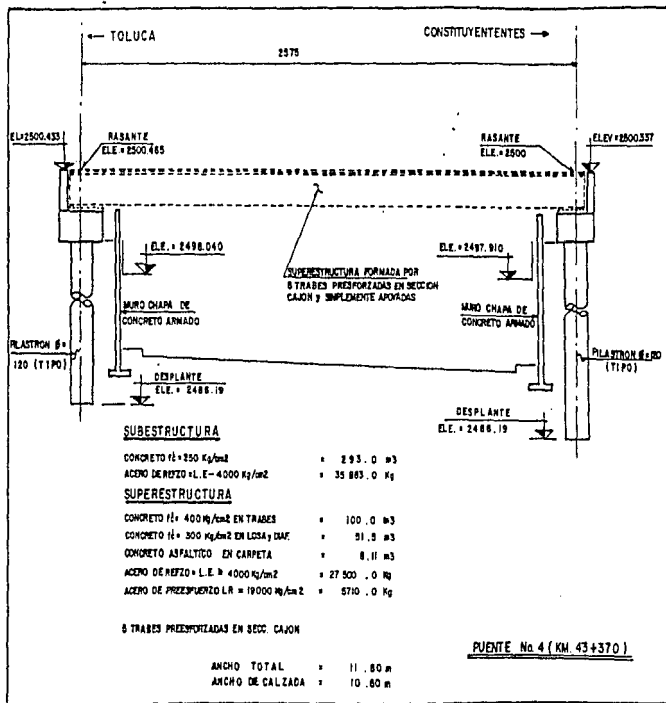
SECCION LONGITUDINAL PUENTE No 4
